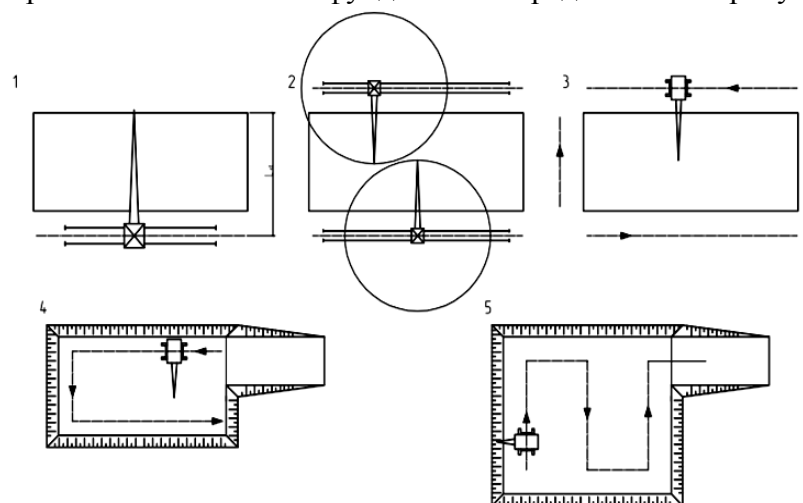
Схема устройства фундаментов многоэтажного здания: по первой и второй схемам фундаменты монтируют башенными кранами или кранами-нулевиками; по третьей, четвертой и пятой схемам фундаменты монтируют самоходными стреловыми кранами
